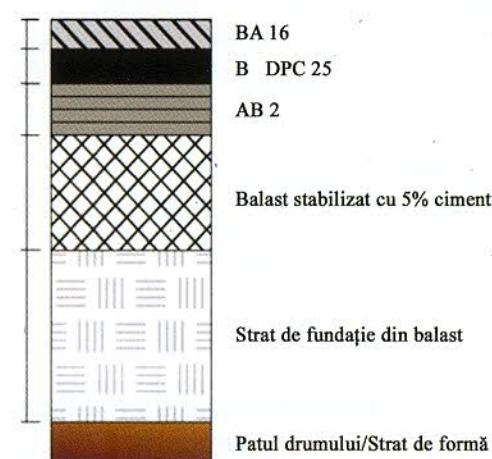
Structură rutieră flexibilă (Alternativa 2)
